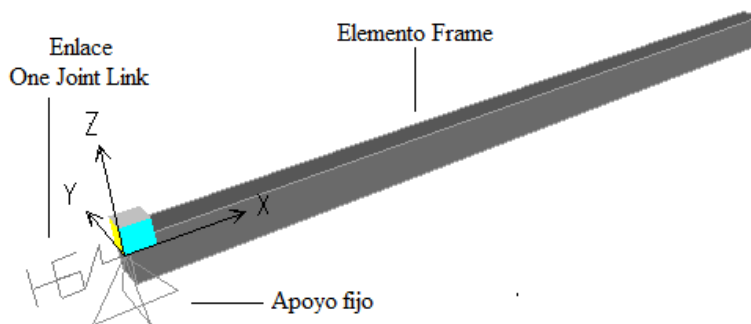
Modelo de elementos finitos de la columna con unión híbrida
